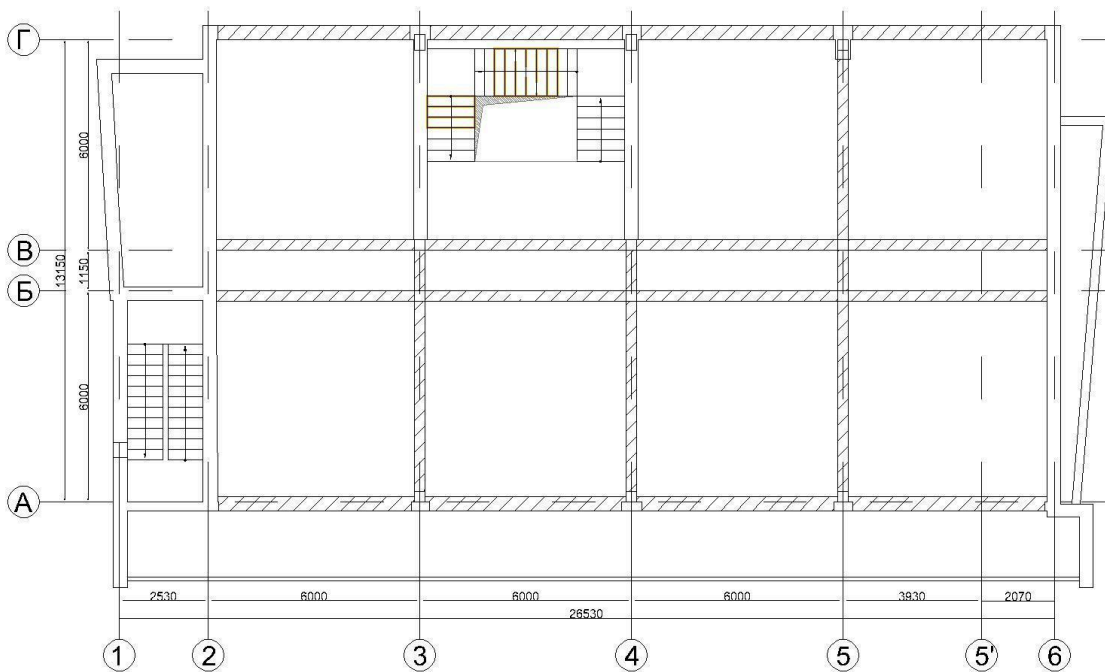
Схема розташування балок під перекриття на типовому плані поверху
